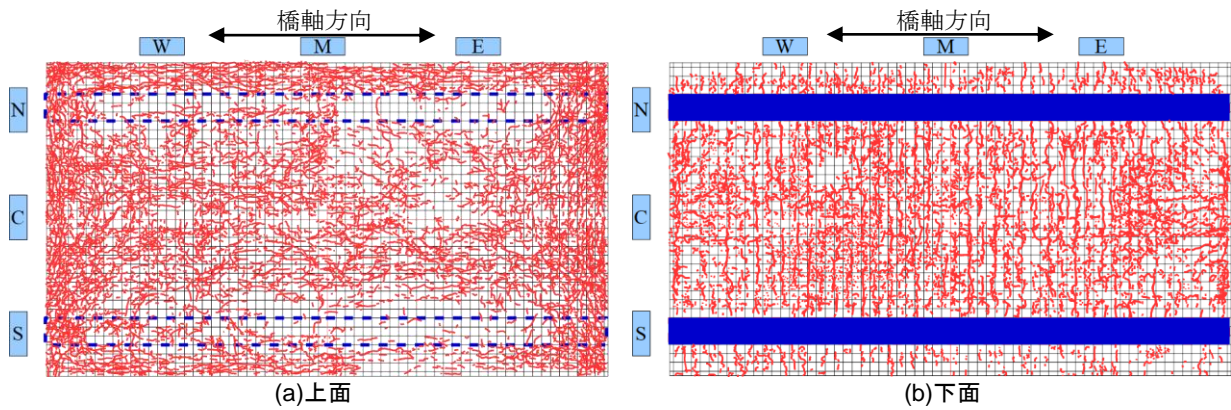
床版に発生したひび割れ(材齢 667 日現在)
